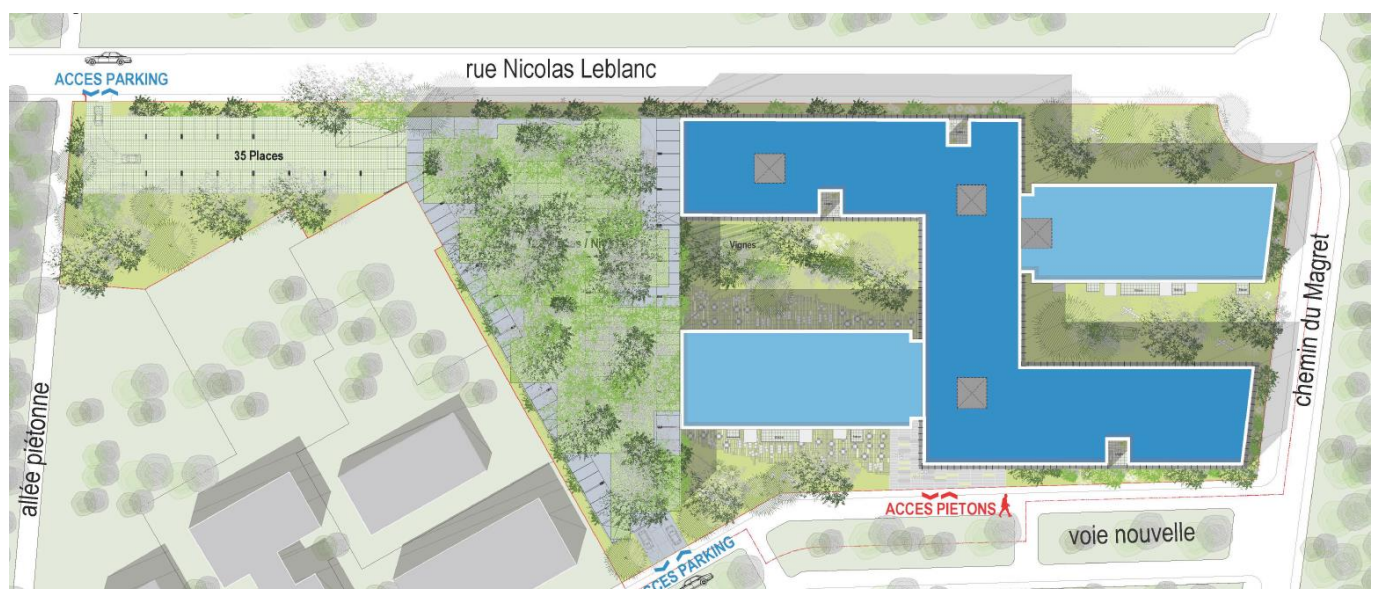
Plan masse du projet. (Source : Hubert Godet Architecte – Notice paysagère)
